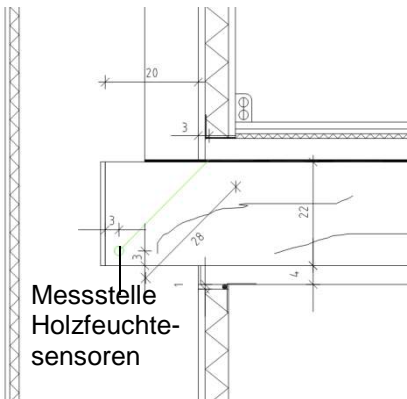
Detail Bauteilanschluss der Innendämmsysteme im Vertikalschnitt durch Wandaufbau und Zwischendecke
